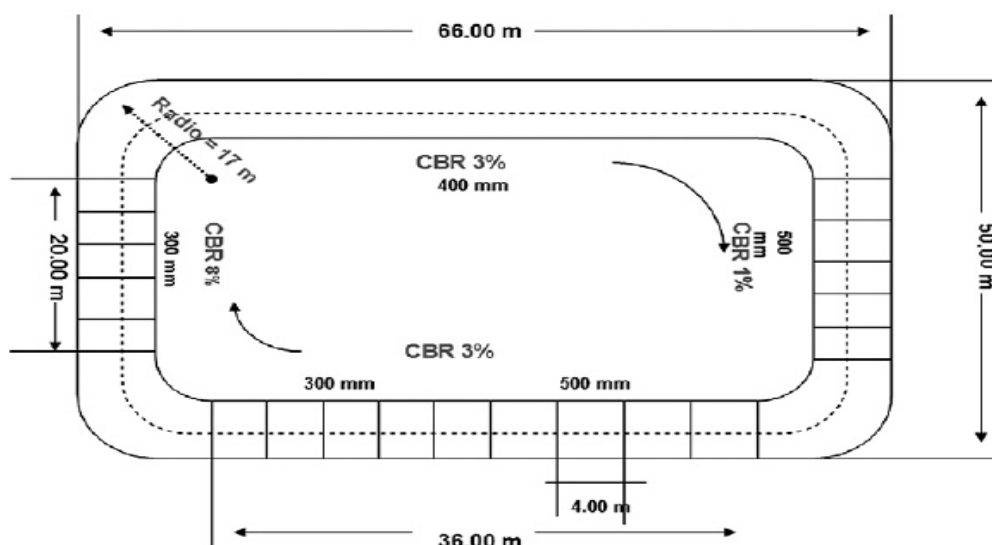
Vista en planta de la sección típica de la vía utilizada en el ensayo
